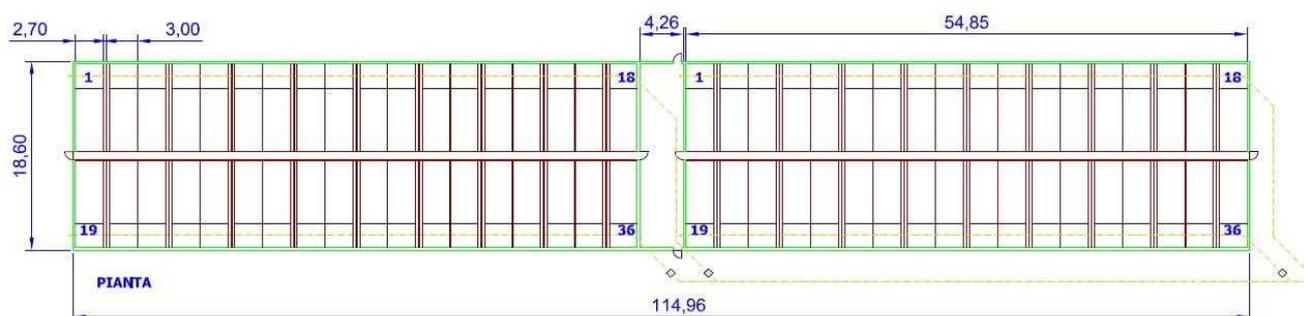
Planimetria e Layout della nuova porcilaia progettata
